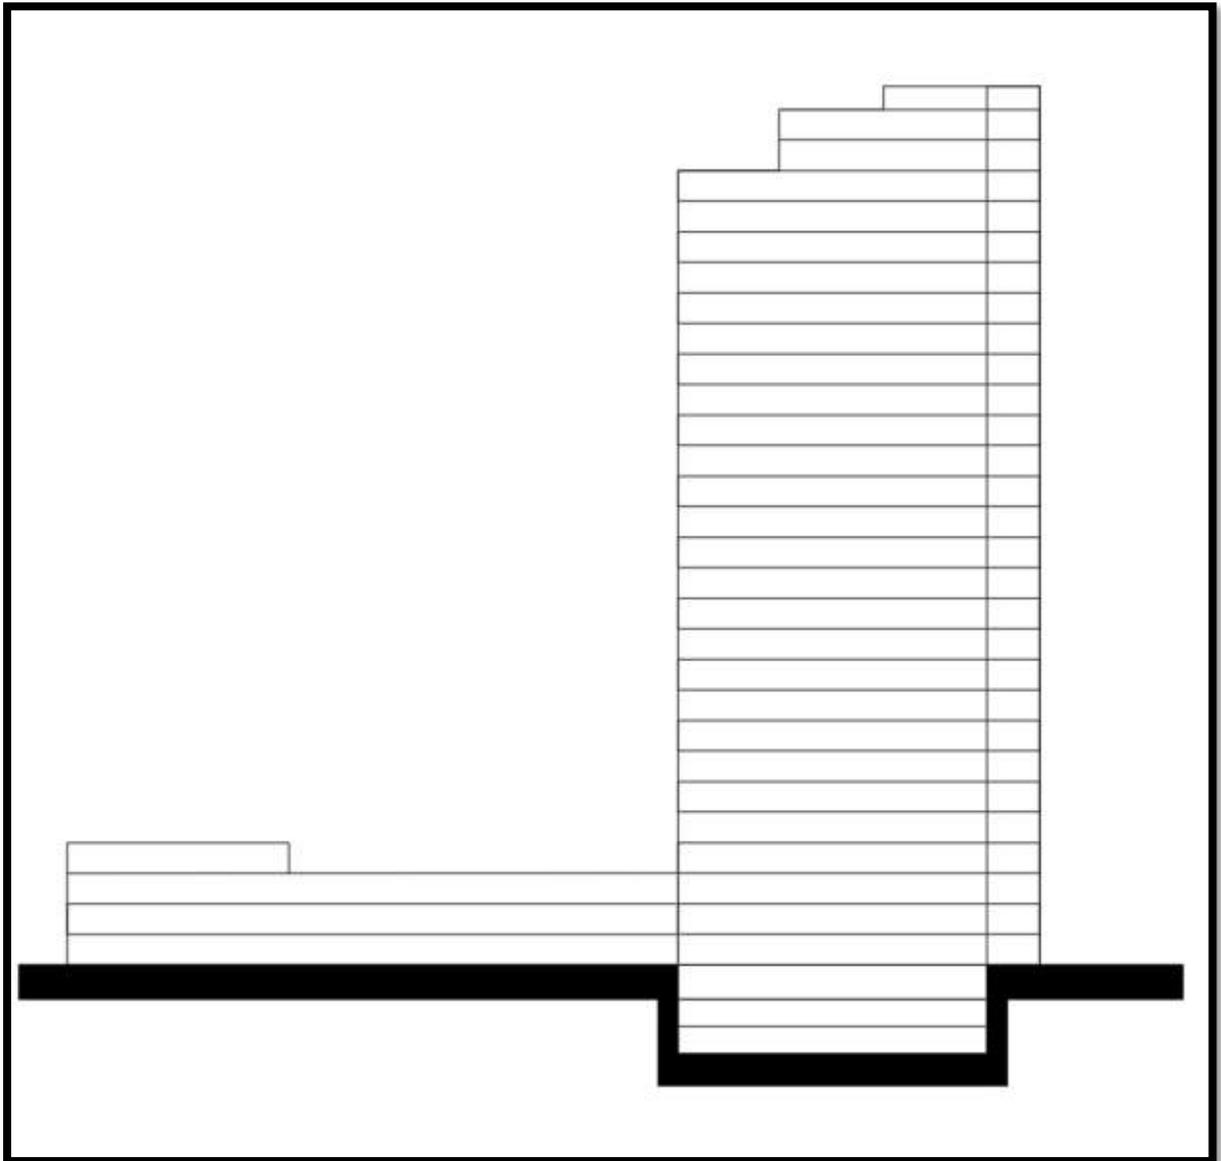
Corte esquemático del emplazamiento en el terreno, Fuente: Elaboración propia.
